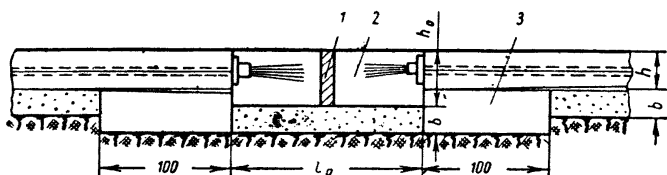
Температурный шов покрытия с продольной арматурой из пучков
